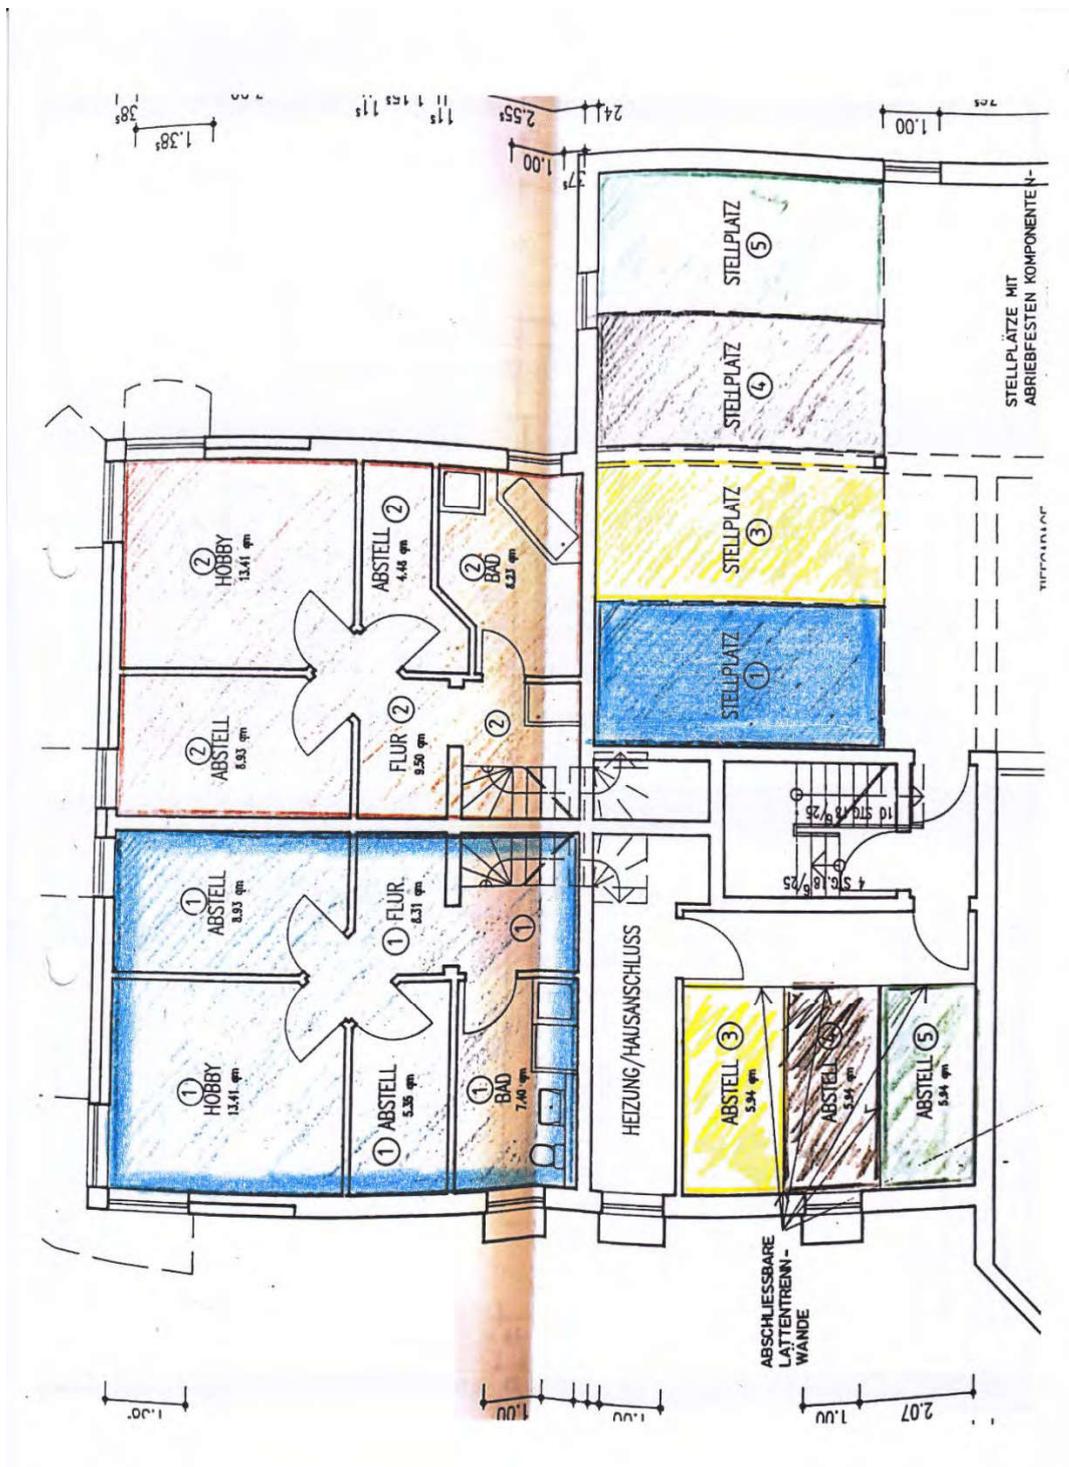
Grundriss KG mit Kennzeichnung der zugehörigen Kellerräume Nr. 1
